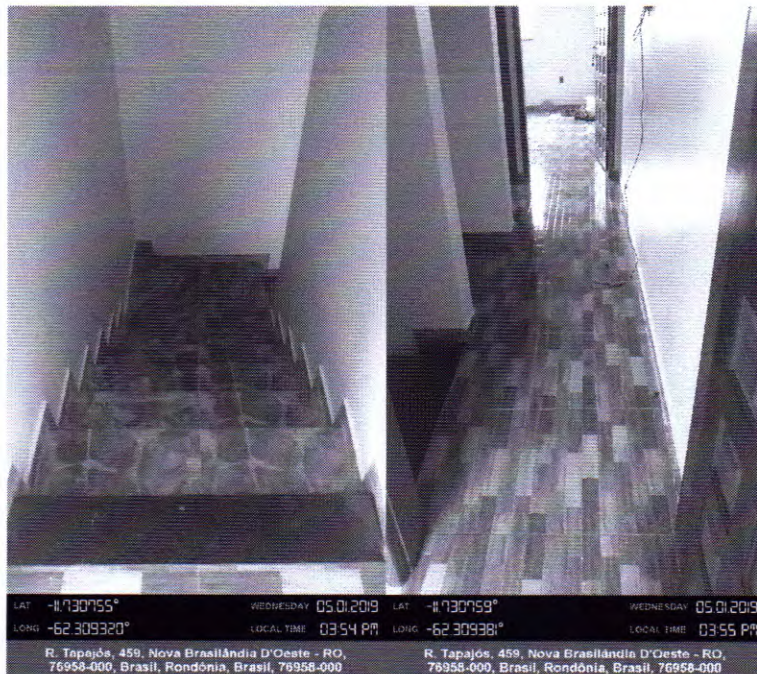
Vista da escada de acesso entre pavimento térreo e superior e corredor de acesso entre as salas superiores..
